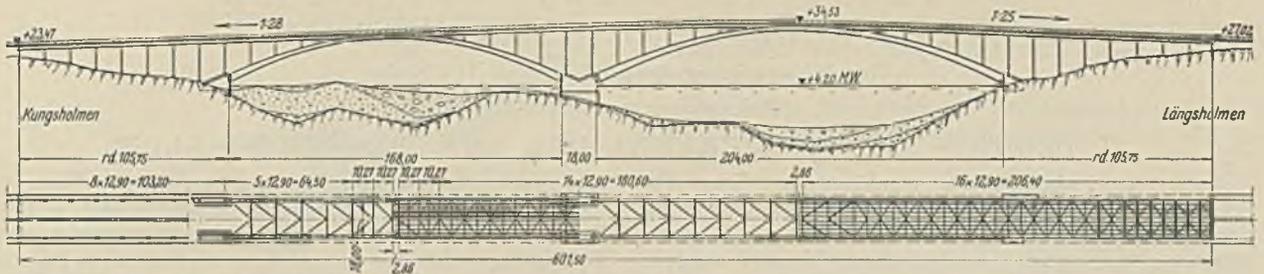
Grundriß und Ansicht der Brücke. M. etwa 1:3750.
